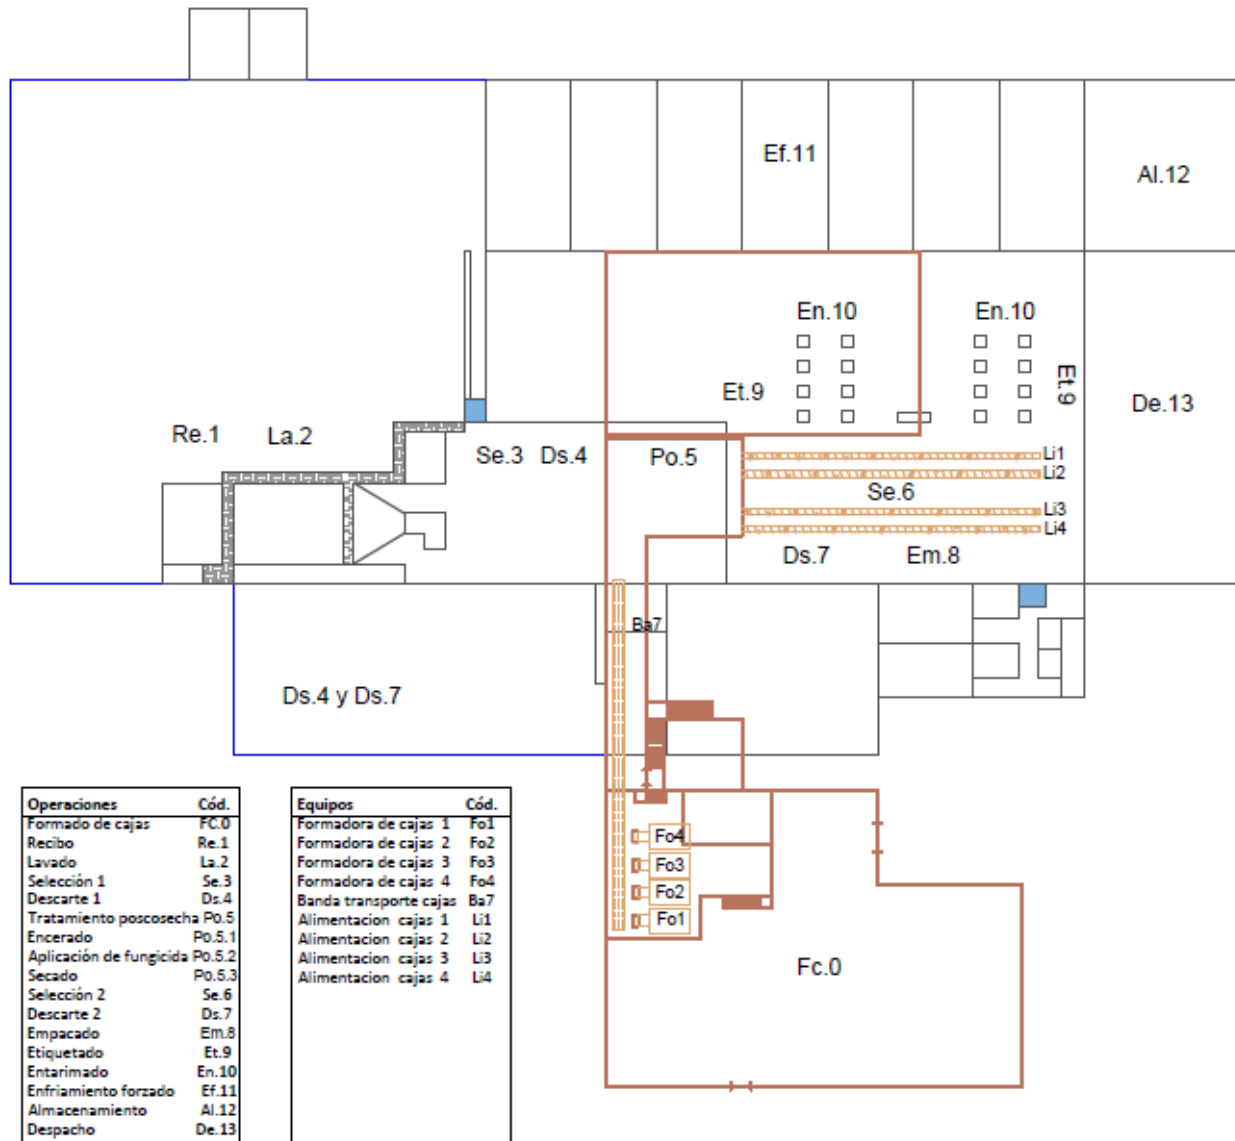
Plano de planta área de cajas de empaque (área resaltada línea color marrón)
